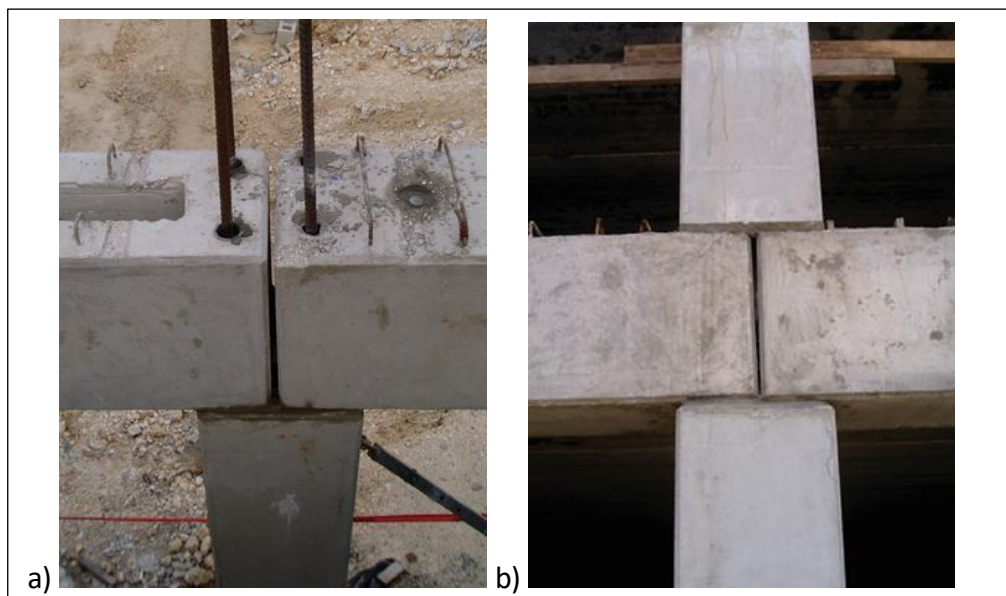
(a) *Assemblage articulé discontinu poutre-poteau ; (b) vue rapprochée de détail[36].
